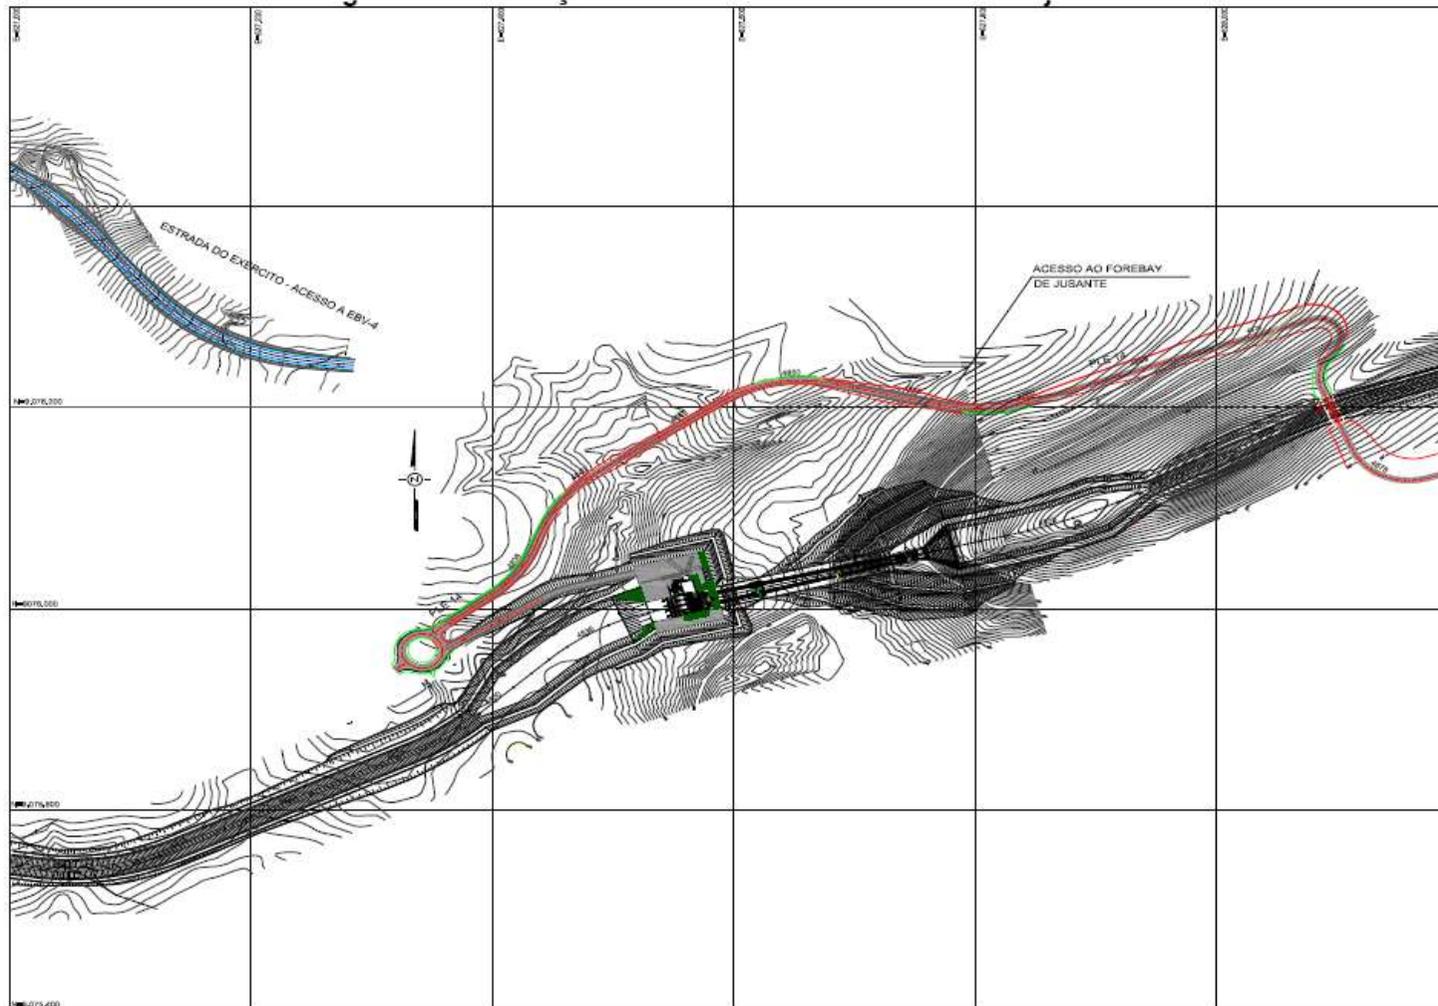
Planta Baixa da EBV-4 – Arranjo Geral
